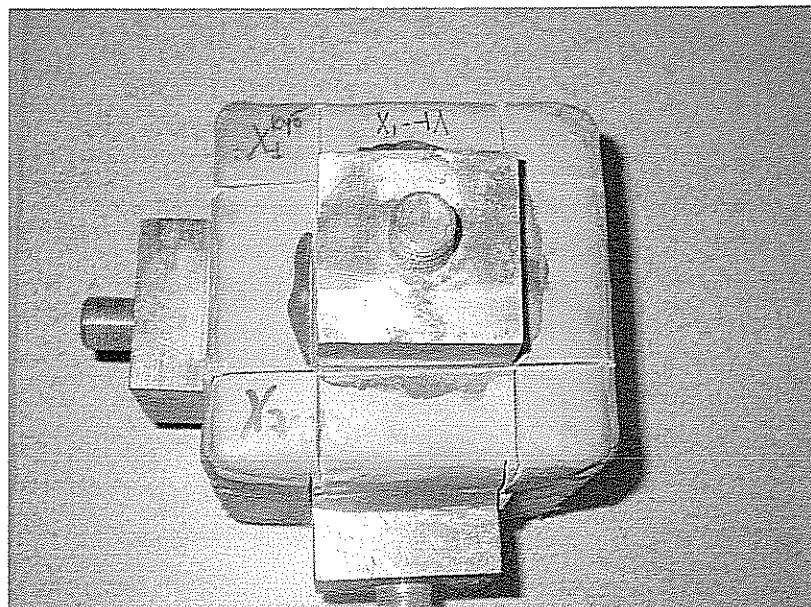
Проведение адгезионных испытаний гидроизоляционного покрытия
